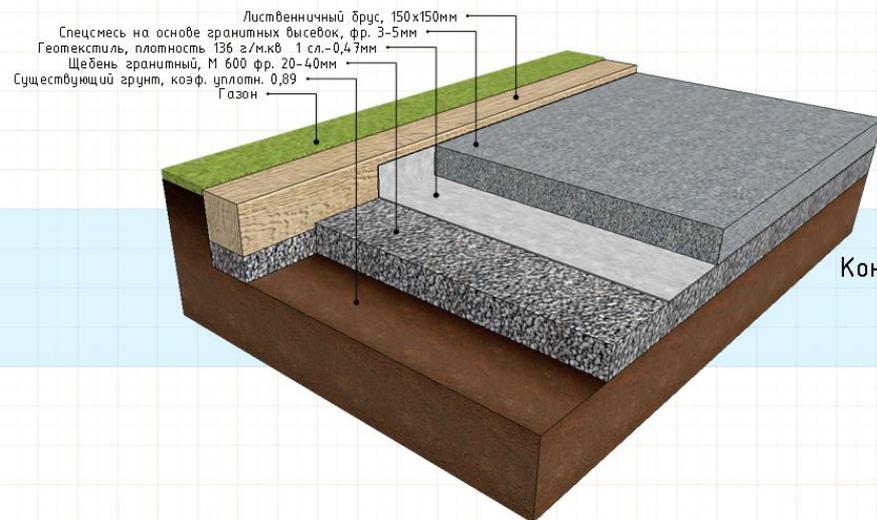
Конструкция простейшей спортивной площадки (разрез) с устройством дренажа. Покрытие – специальная смесь из высевок
